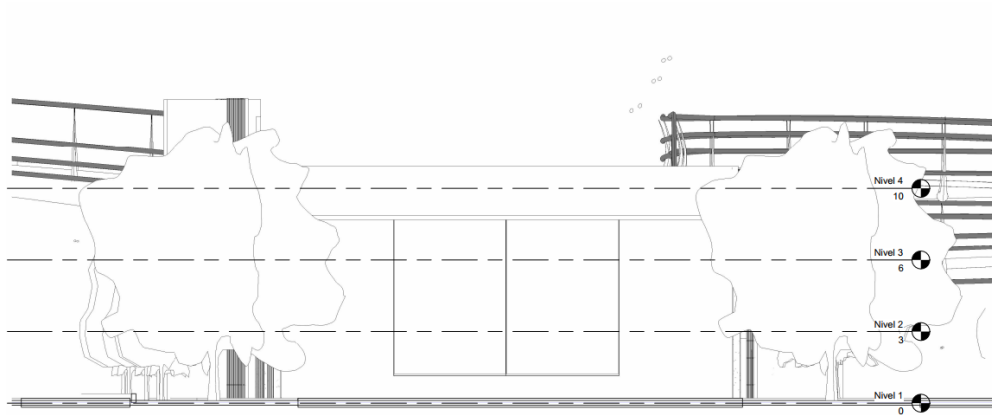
Fachada oriente, muro ciego que se abre para generar la conexión al auditorio y permite su relación con el exterior
